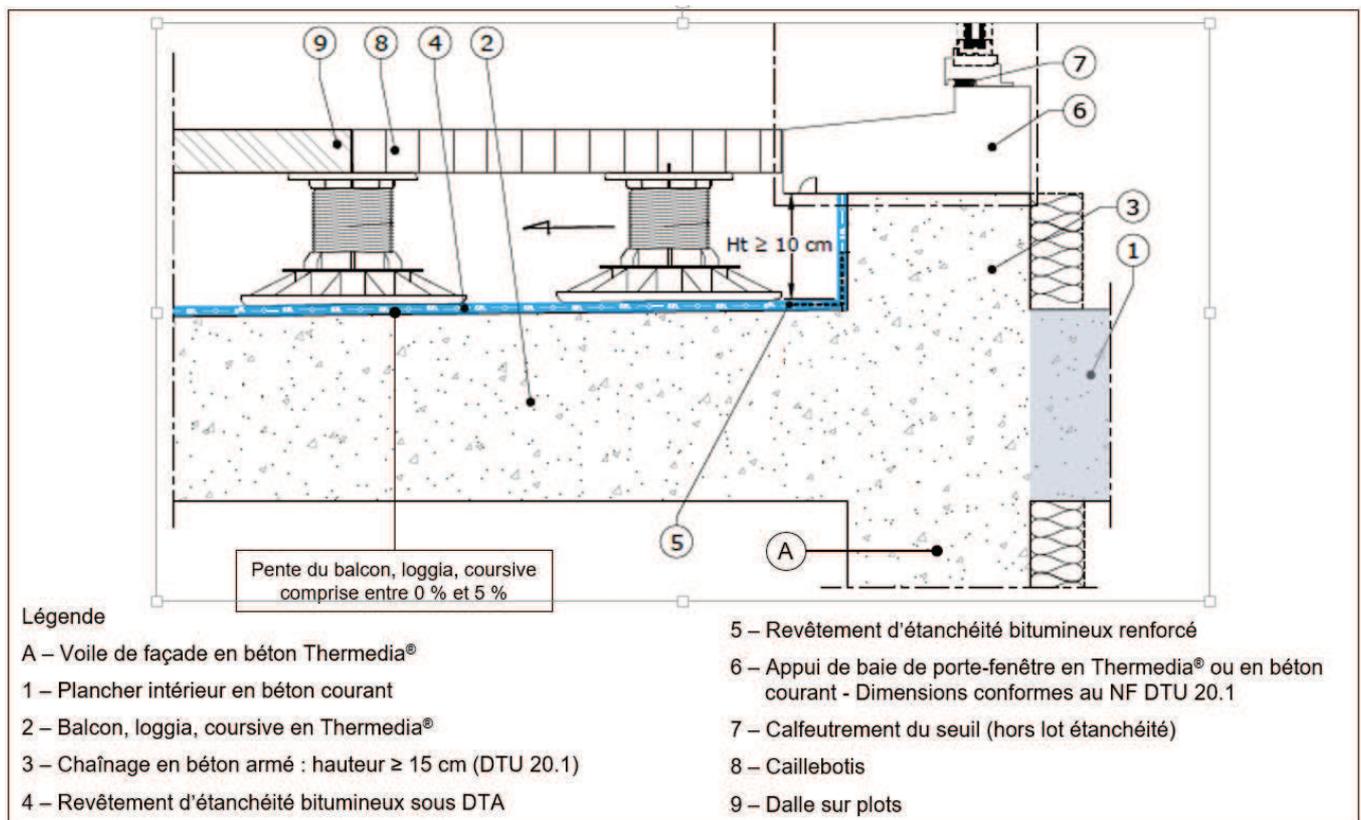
Exemple de balcon, loggia ou coursive avec étanchéité par un revêtement bitumineux sous DTA avec protection par dalles sur plots - Seuil avec relevé de 10 cm de hauteur.
